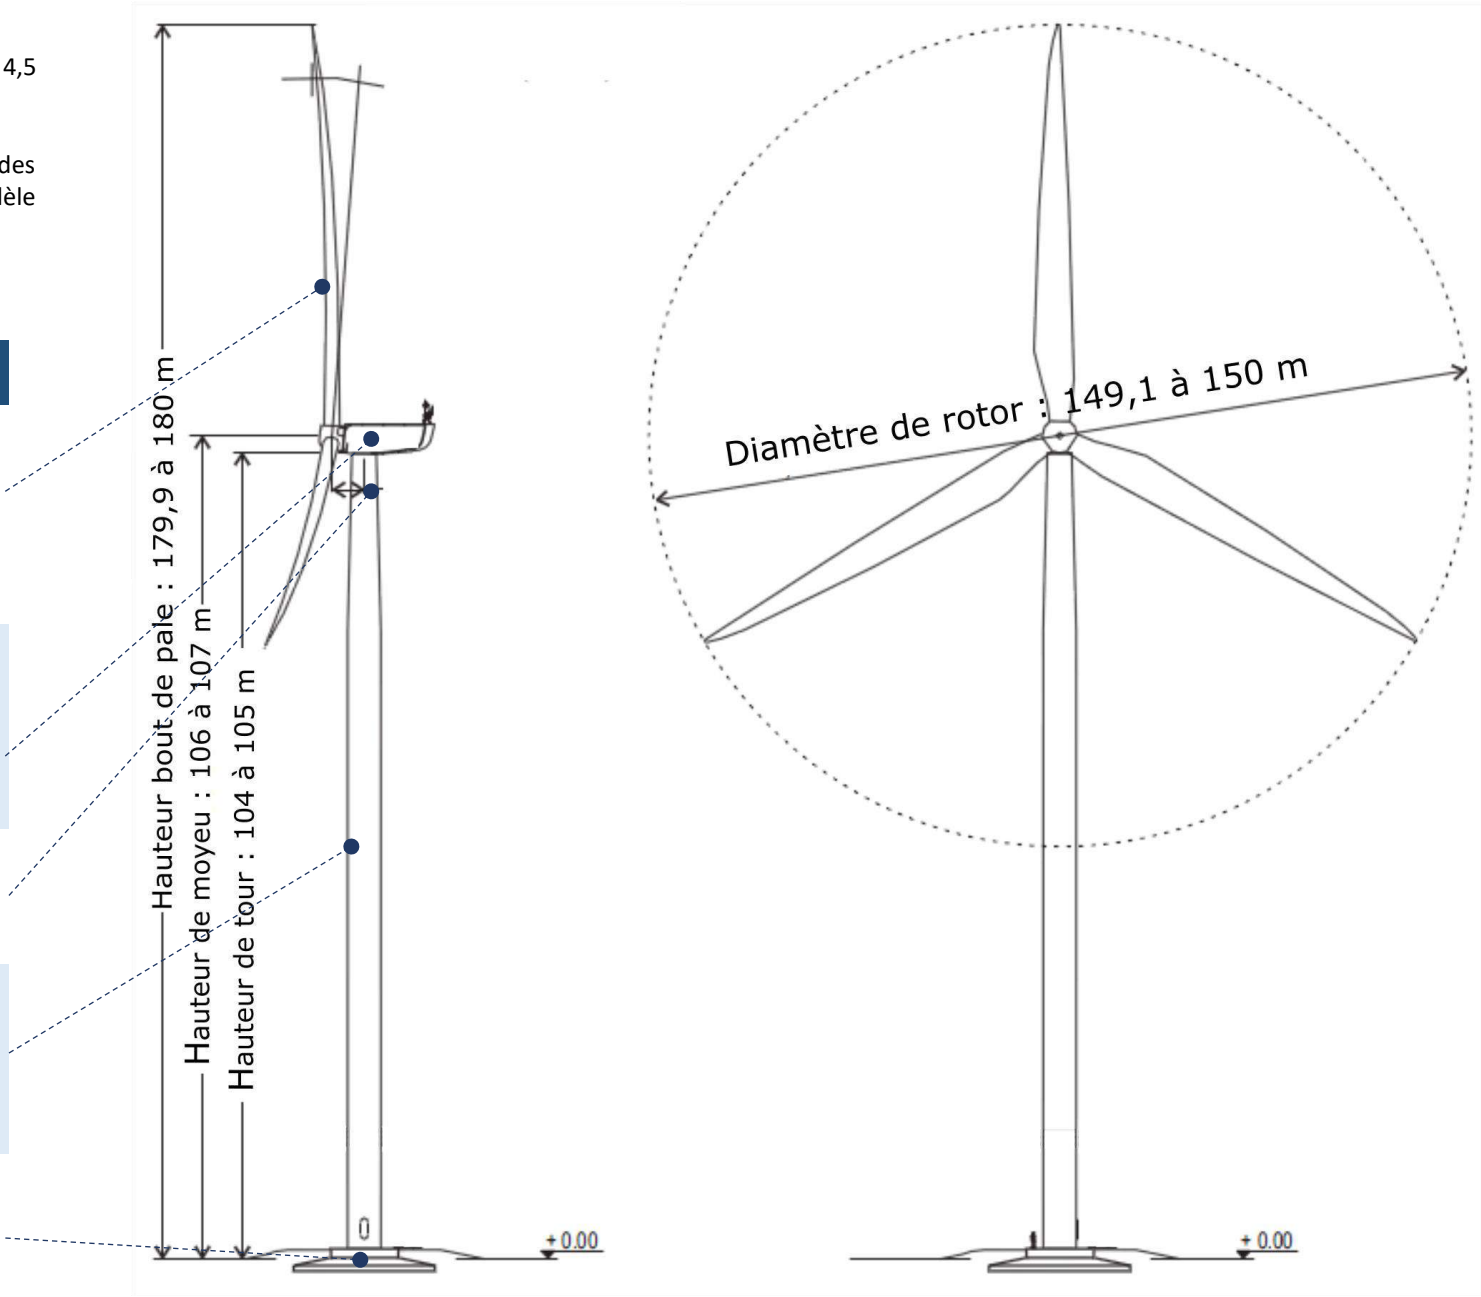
Plan d'élévation du gabarit-type d'éolienne prévu
